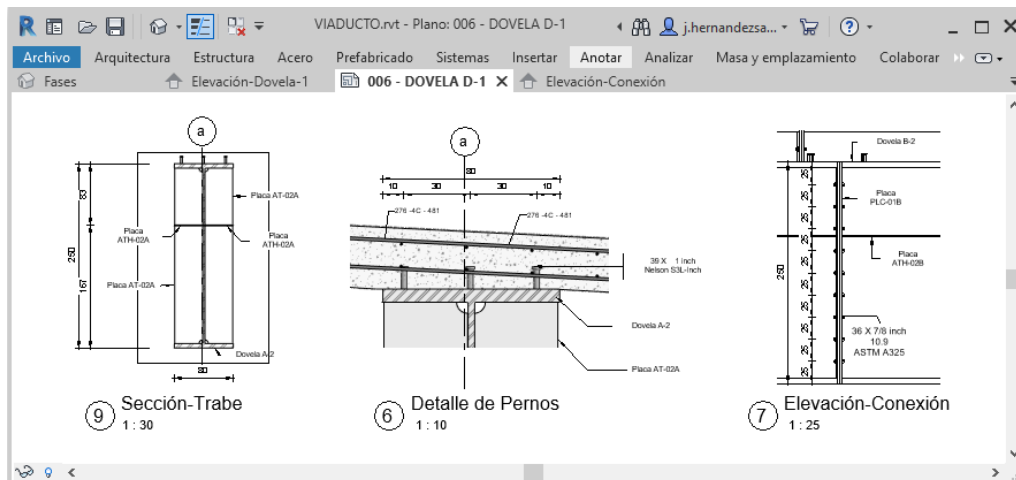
Detalles estructurales con anotaciones. Fuente: Elaboración propia
